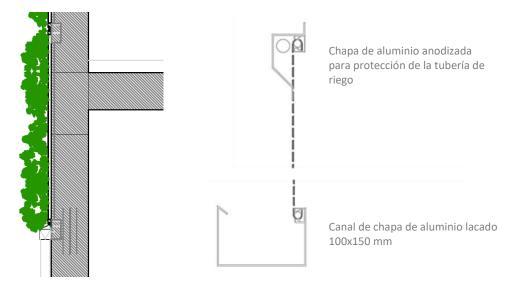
Detalle constructivo de mBiGToldo. Fuente: Proyecto básico y de ejecución EB1 de Horta das Figueiras
